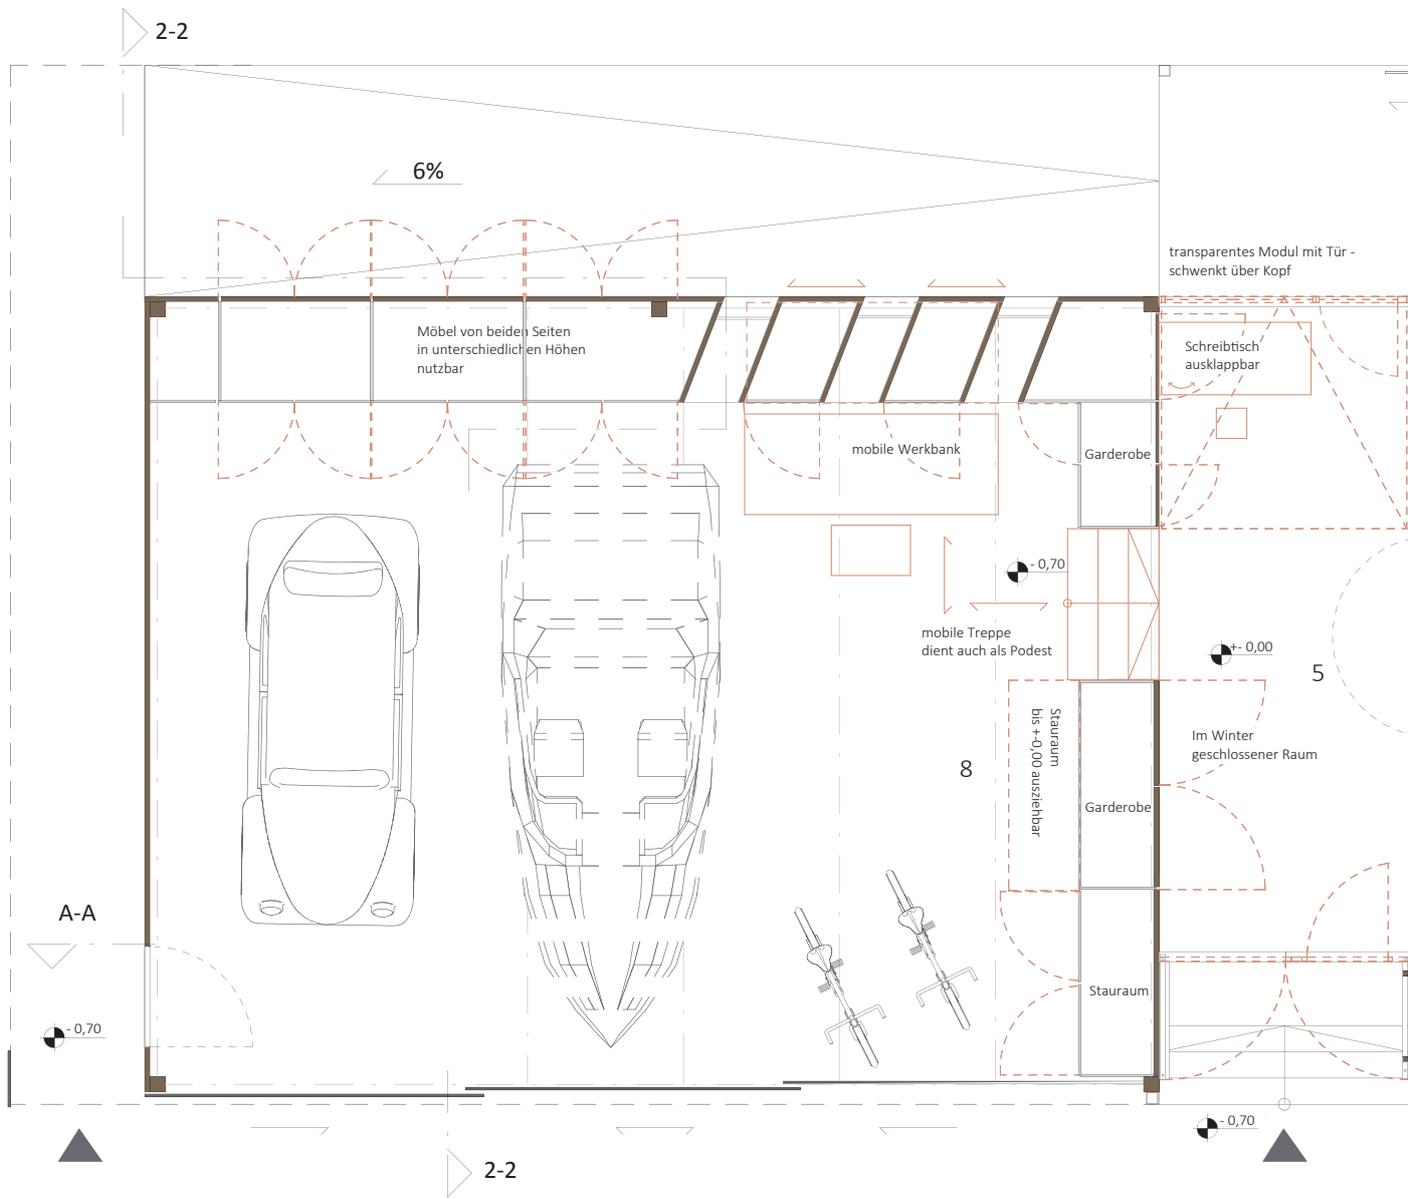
Grundriss - Ein-Raum-Haus
